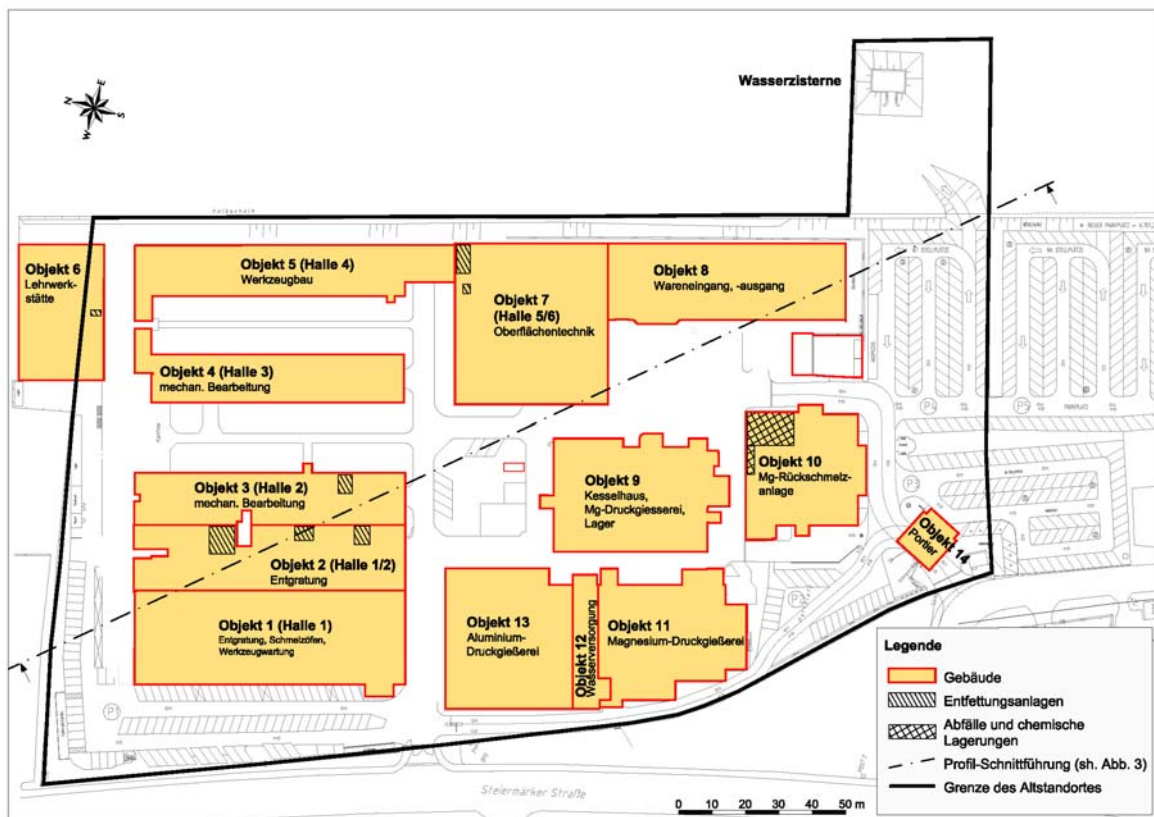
Übersichtslageplan – bestehende Bebauung, Aufstellungsorte von Entfettungsanlagen sowie ehemaliges Abfall- und Chemikalienlager
